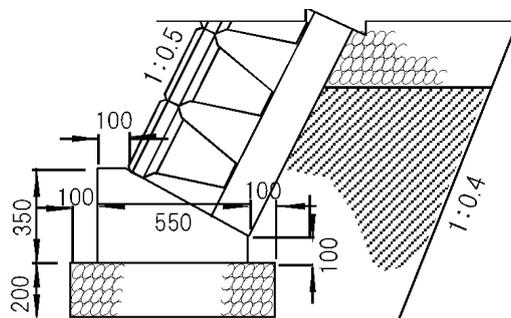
基礎工の設計標準の一例（出典：小構造物標準設計図集（鳥取県県土整備部））
